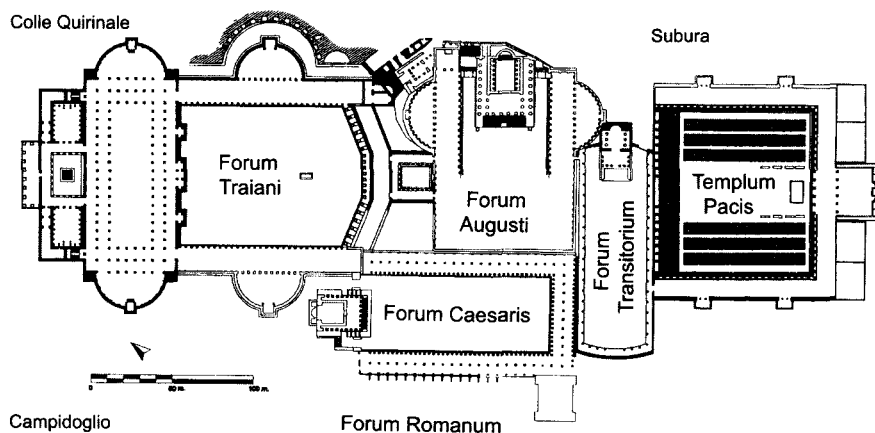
Planimetria dei Fori Imperiali all'età di Traiano.
